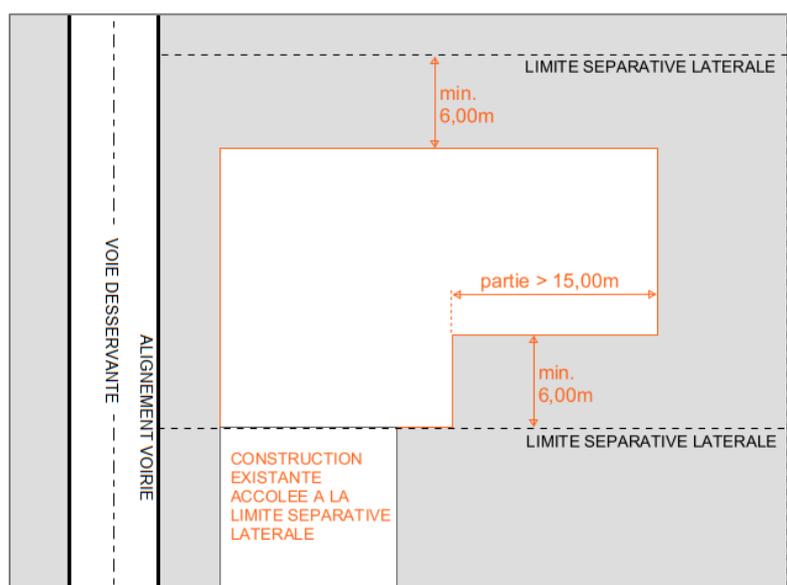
Implantation perpendiculaire d'une construction dont le côté le plus long est supérieur à 15,00 m et construction existante accolée à la limite séparative
